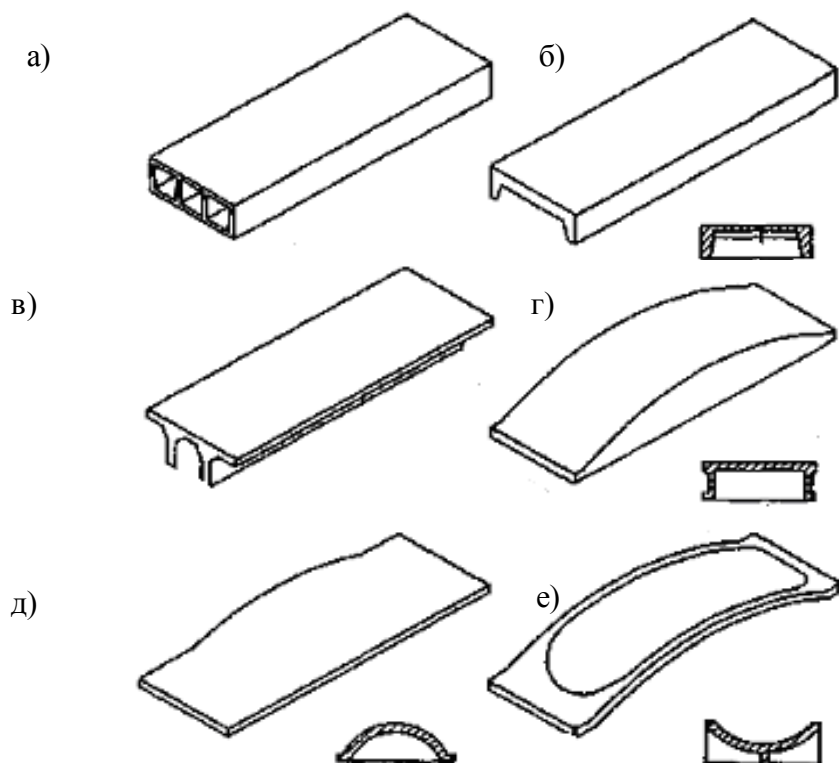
Длинномерные сборные железобетонные настилы покрытий:
